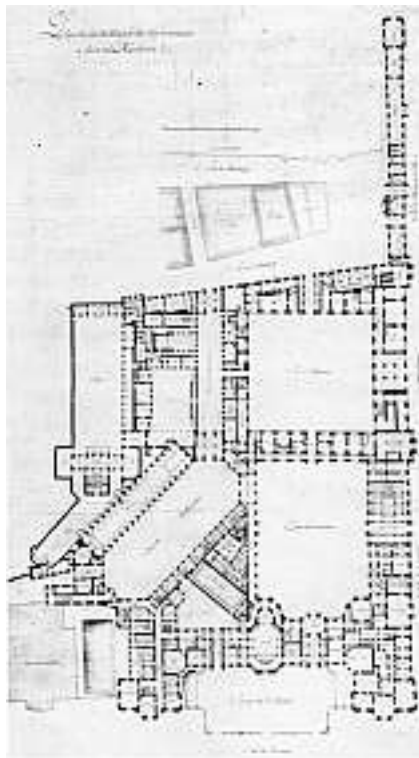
François Cuvilliers d. Ä., Grundriss des Erdgeschosses der Münchner Residenz
